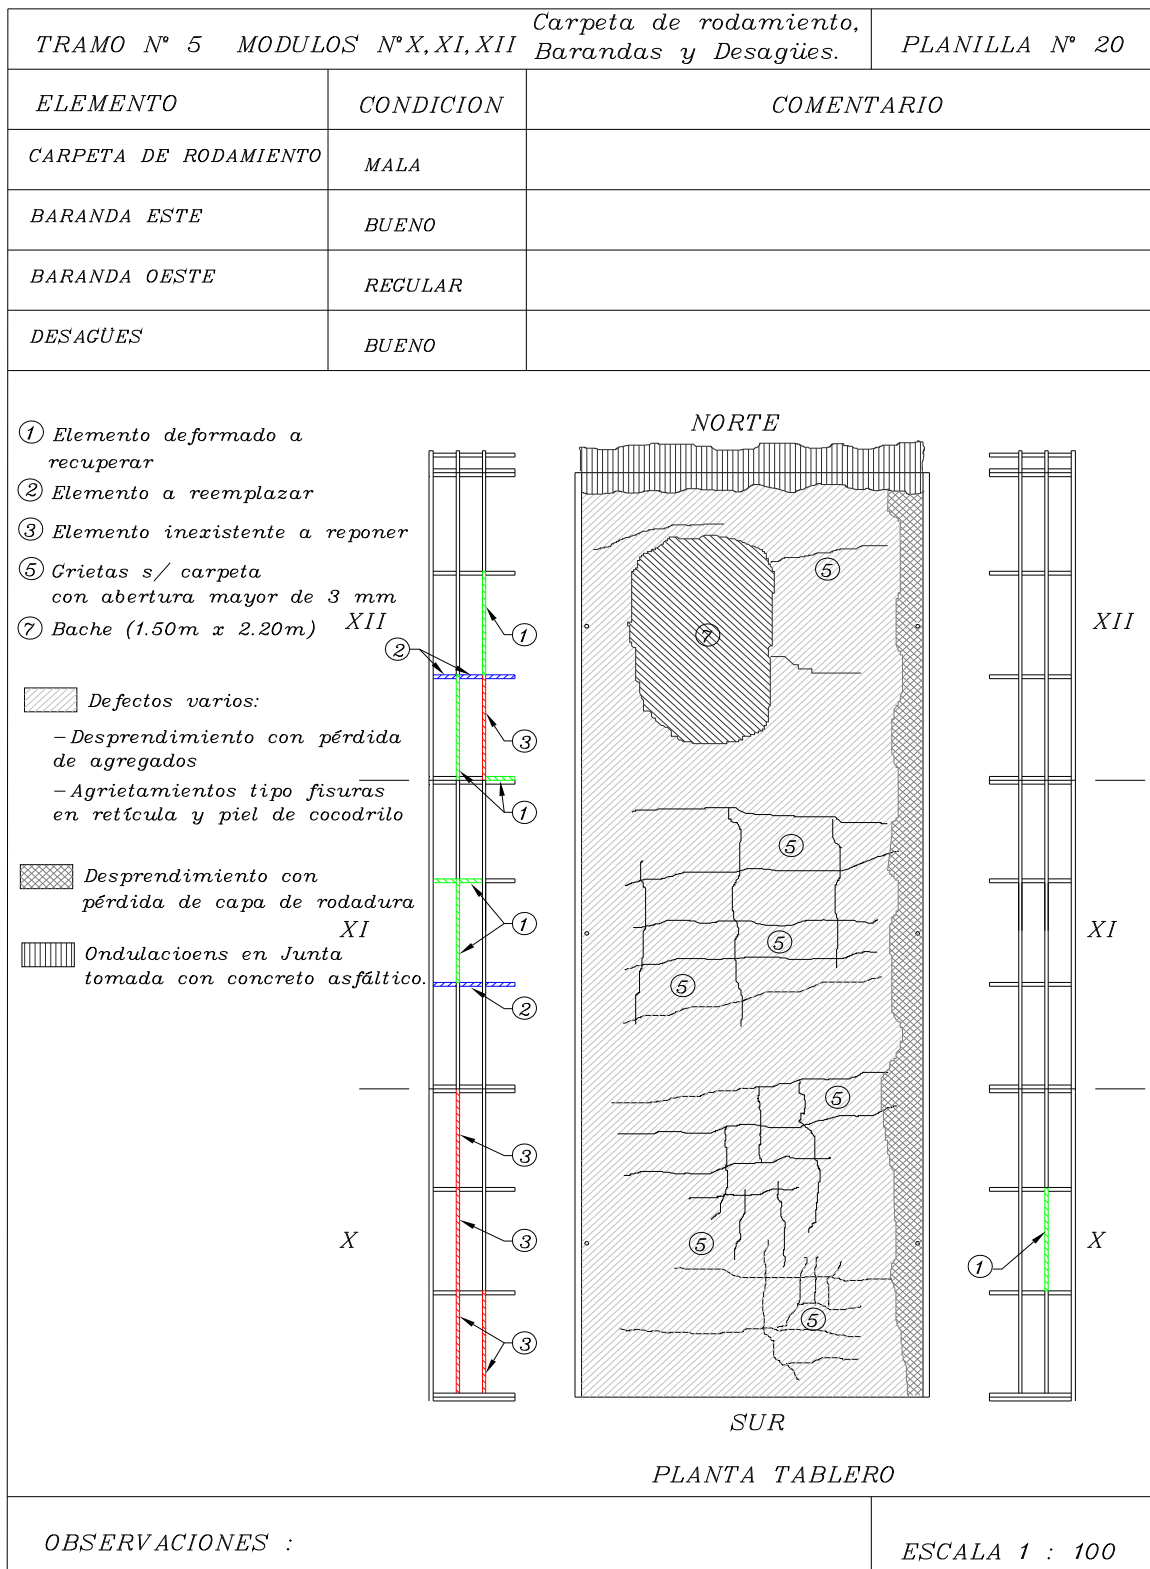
Planilla de inspección de daños en carpeta de rodamiento y barandas
